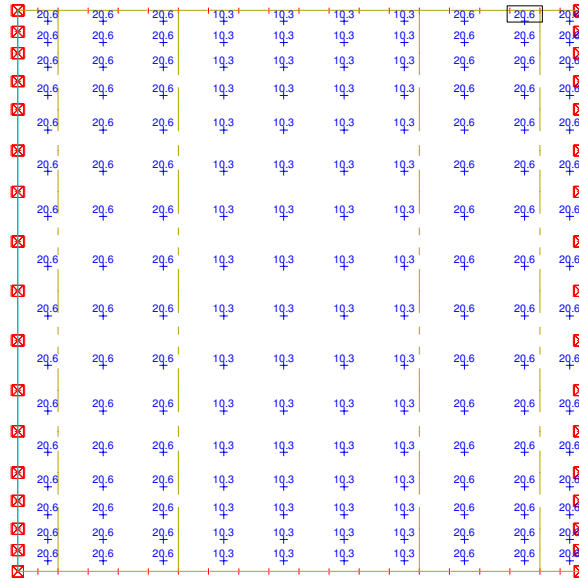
Armadura Superior Longitudinal, Recubrimiento Mecánico 46mm.
